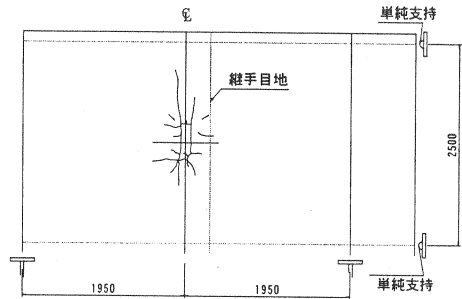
定点疲労試験終了時に観察された床版下面におけるコンクリートのひび割れ状況
